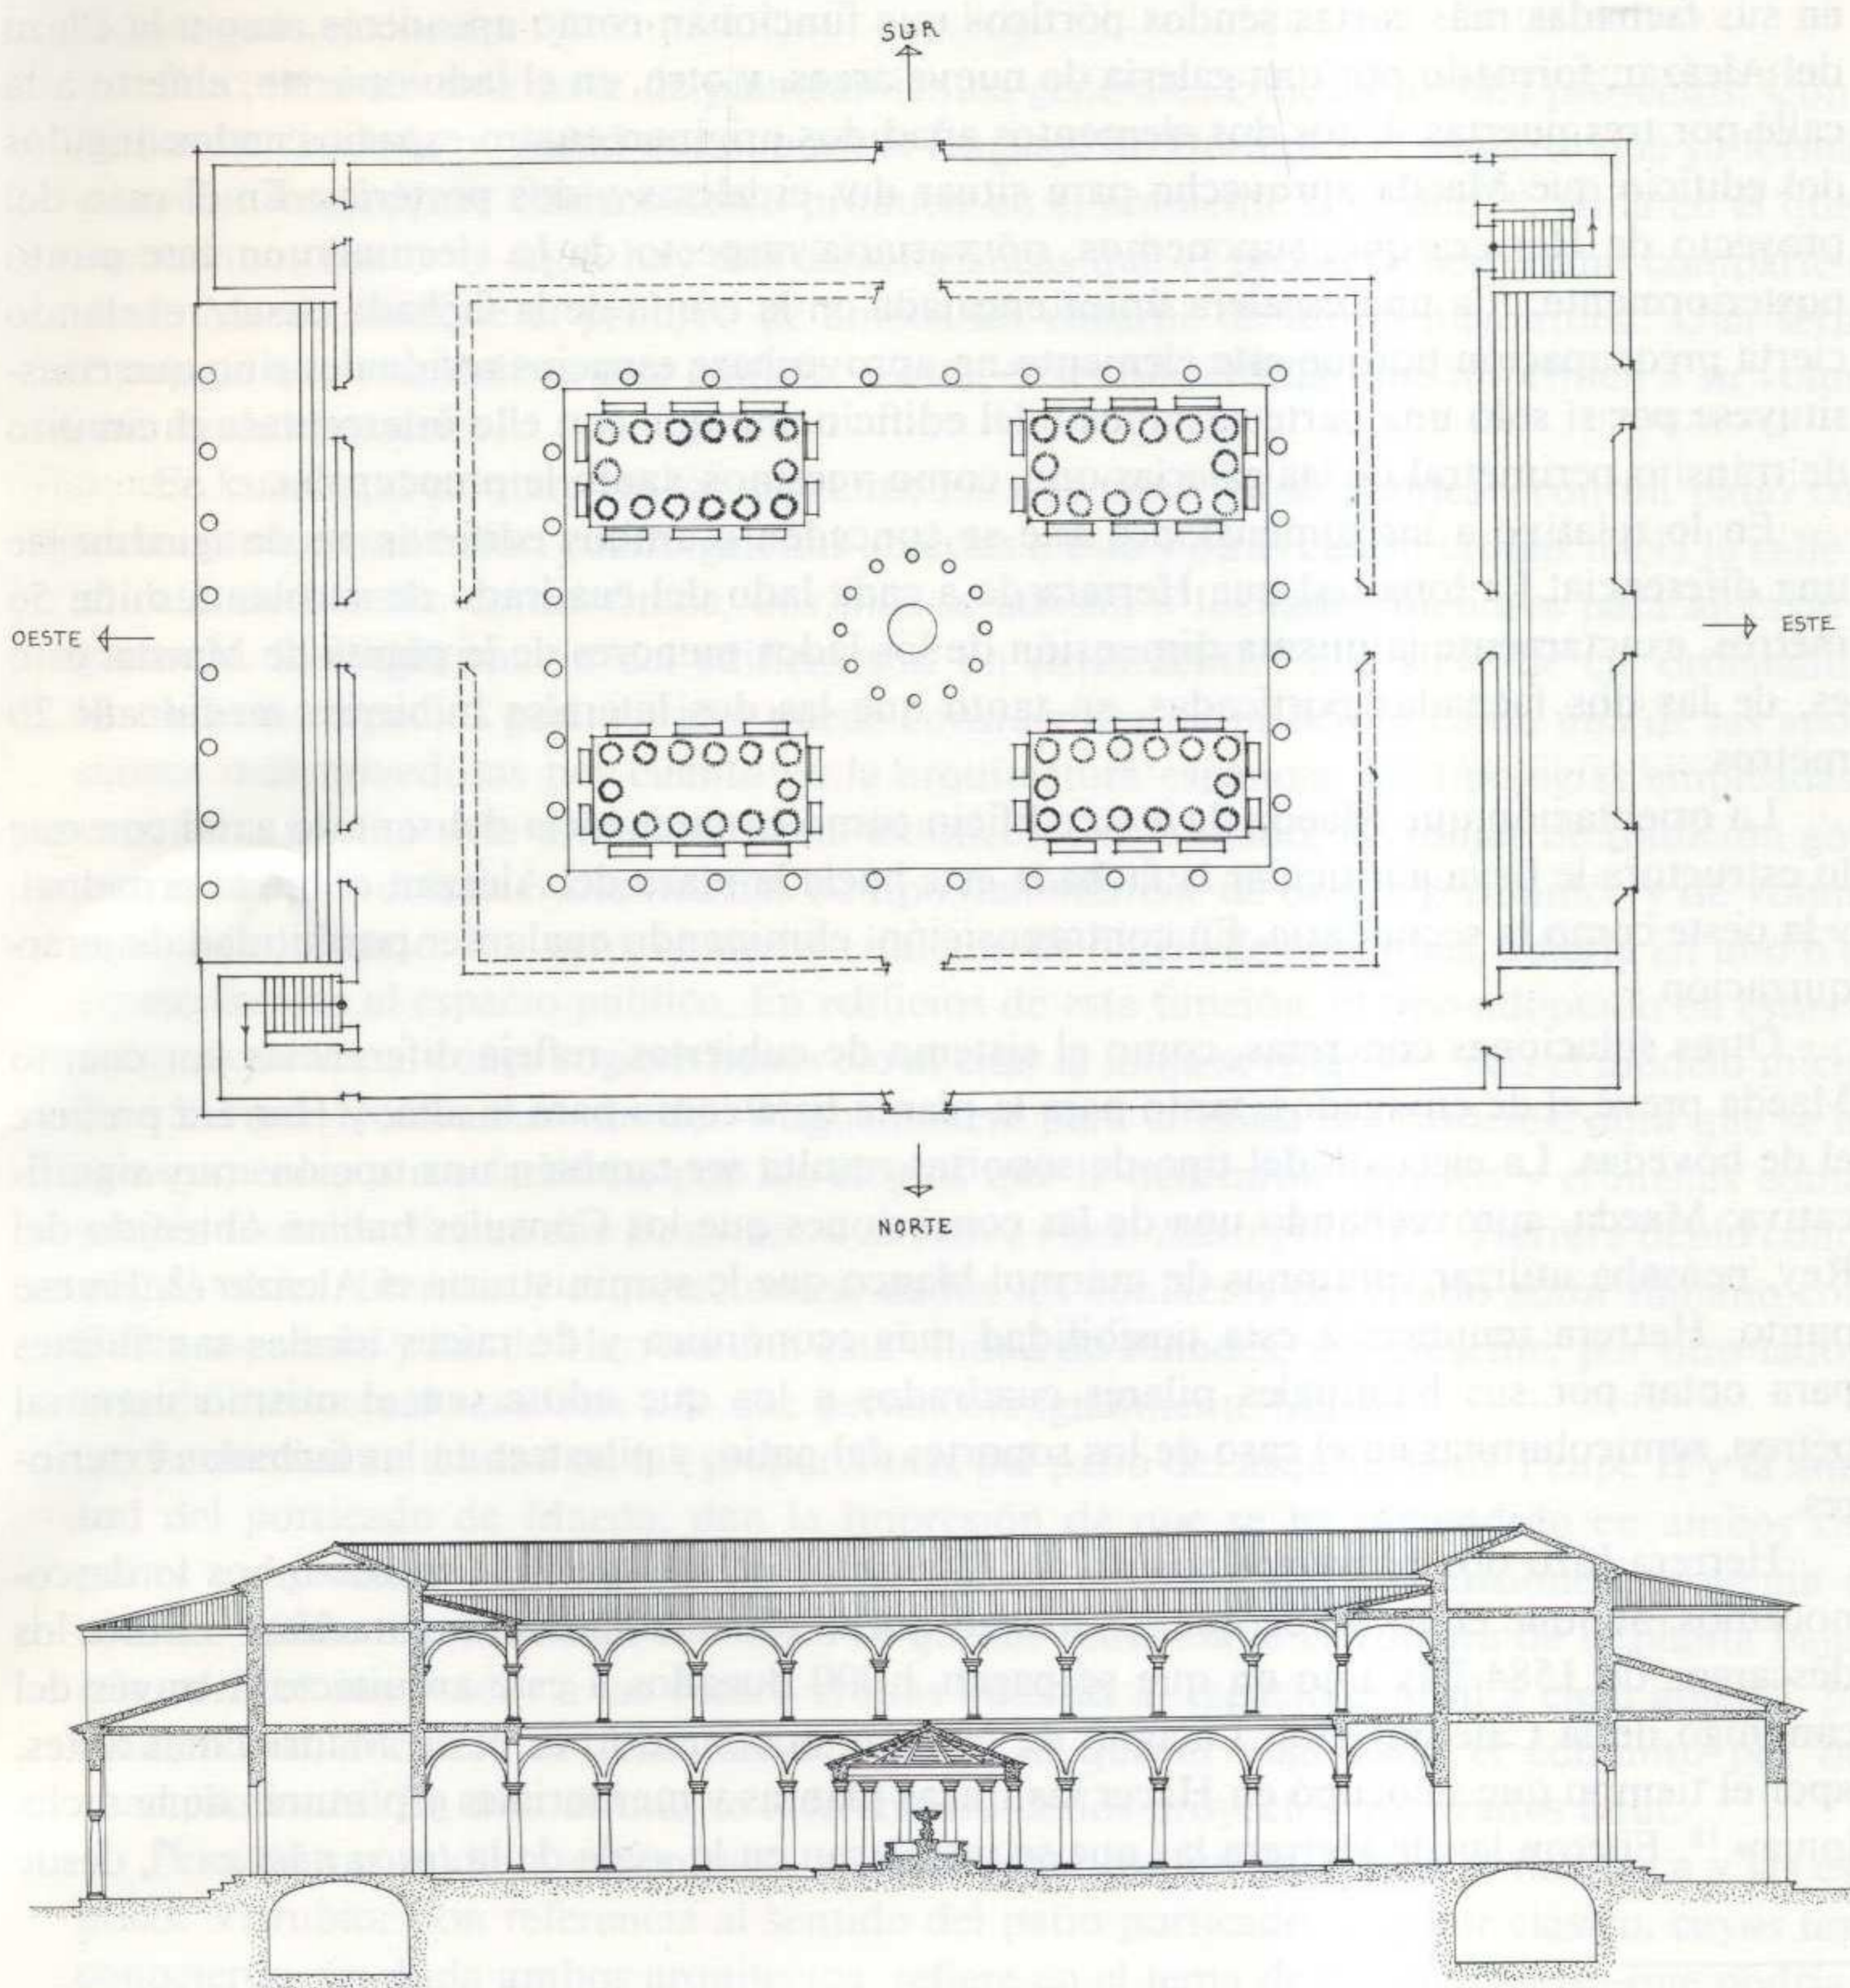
Maeda. Planta y alzado para la *Lonja de mercaderes de Sevilla
